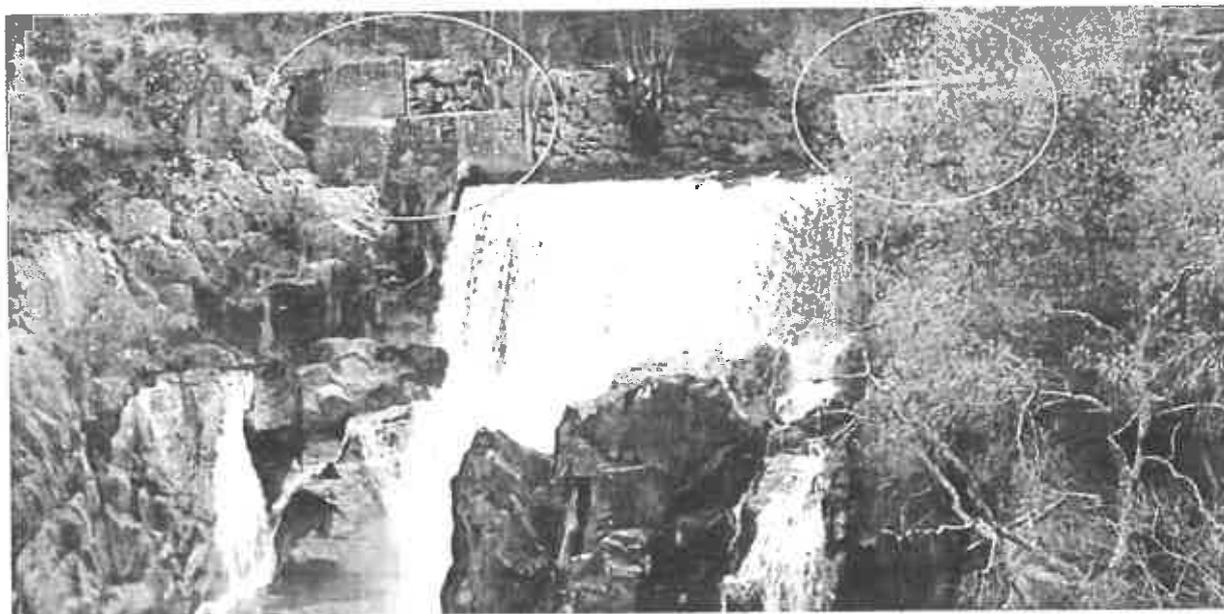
Patamares existentes que vão servir de apoio à nova ponte
